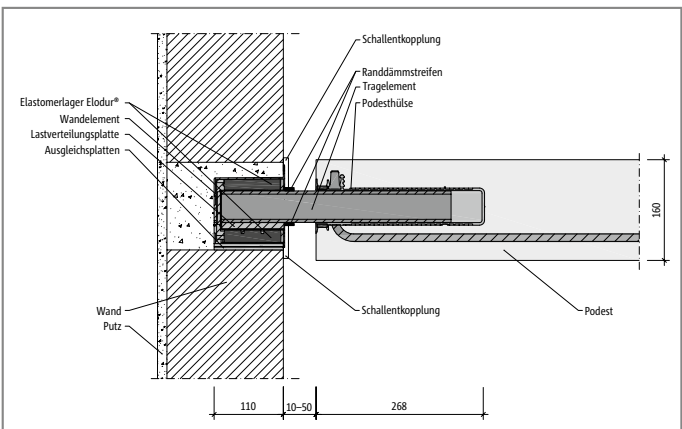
Schöck Tronsole® Typ P: Einbausschnitt mit Elementpodest und Luftfuge
